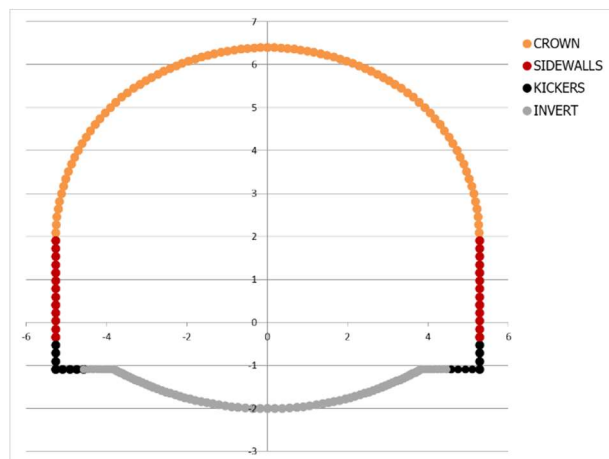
Modello di suddivisione della sezione tipo 1 – Sostegno definitivo
